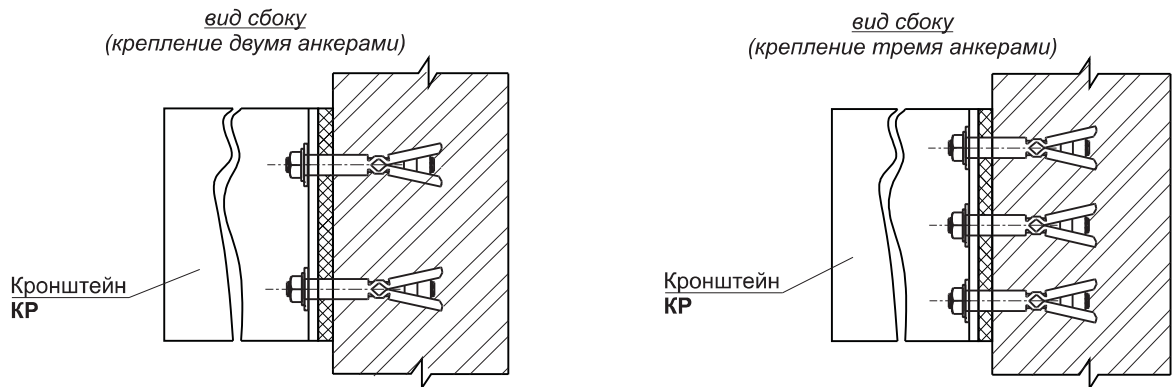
Узел крепления кронштейна КР к стене.
